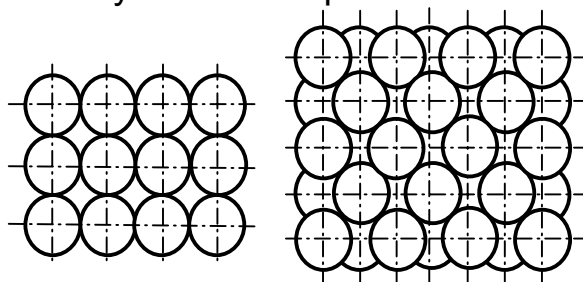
Корпуса из круглых силосов с различными схемами расположения силосов: а- с рядовым расположением цилиндрических силосов; б- с шахматным расположением
